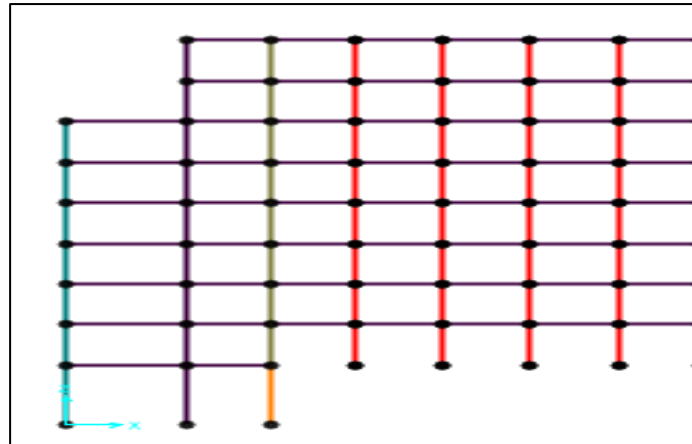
Vue des poteaux et poutres du bloc B.
